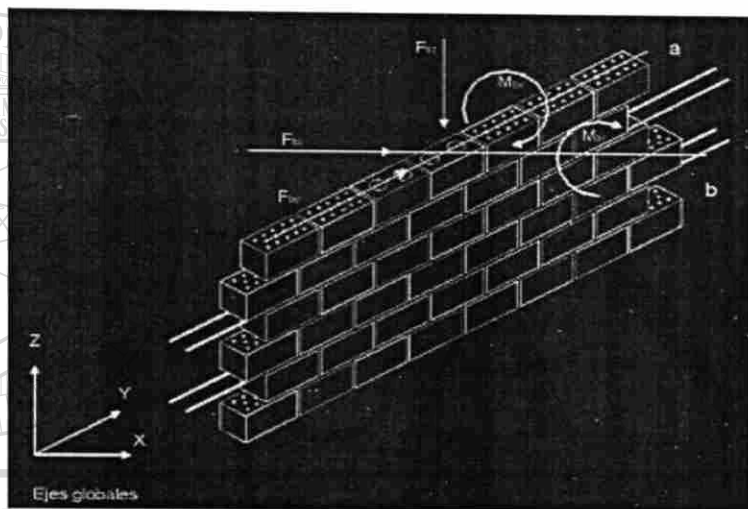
Condiciones de carga en un muro de mampostería.
